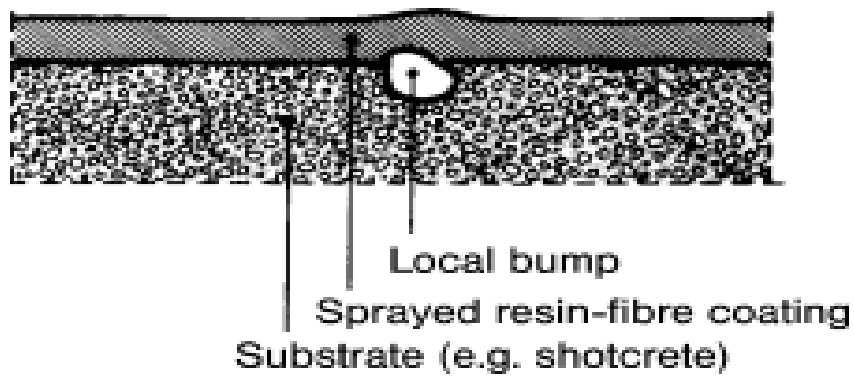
Impermeabilización con resina, sobre los elementos de soporte.
